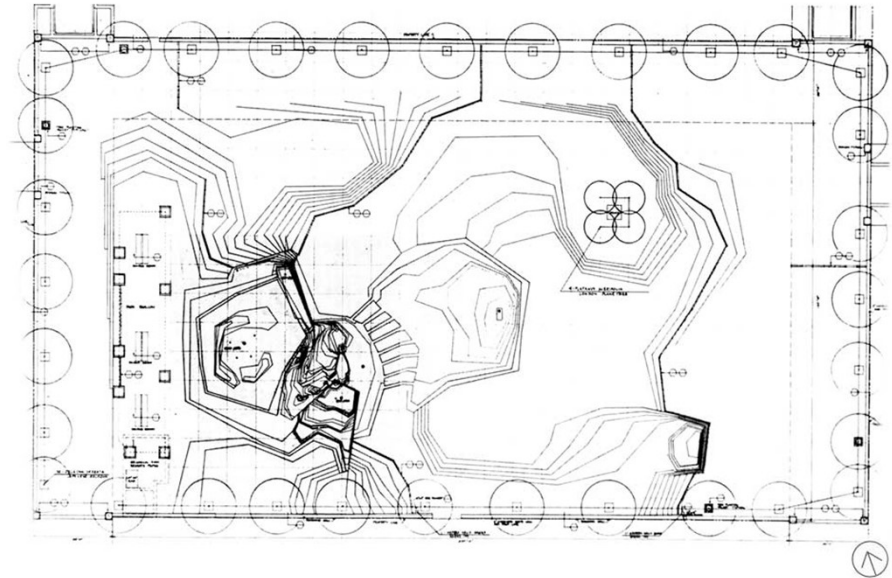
Planta arquitectónica de la fuente de la Plaza Lovejoy, realizado por Lawrence Halprin.
